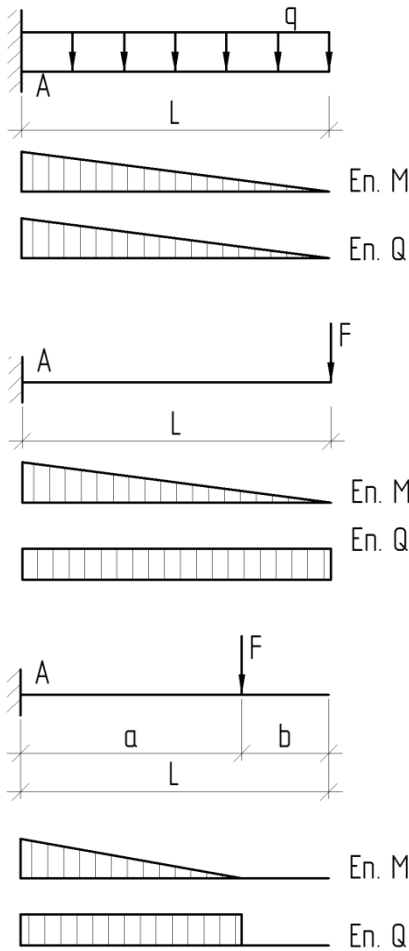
Схеми навантаження балок (однопрольотна балка)
